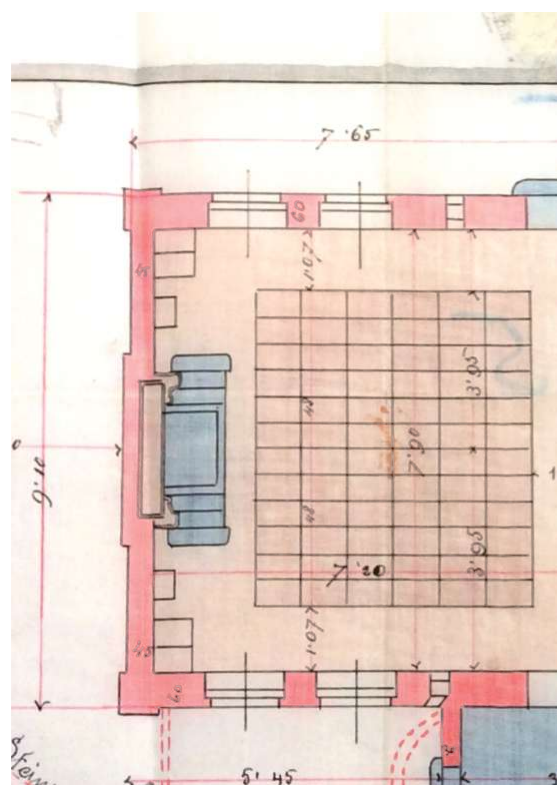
Grundriss Einreichung (1884) [ma37]
